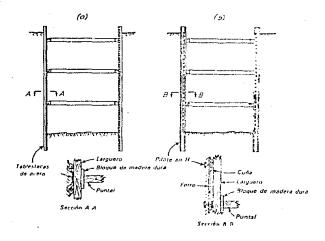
SECCIONES DE ADEME EN EXCAVACIONES
